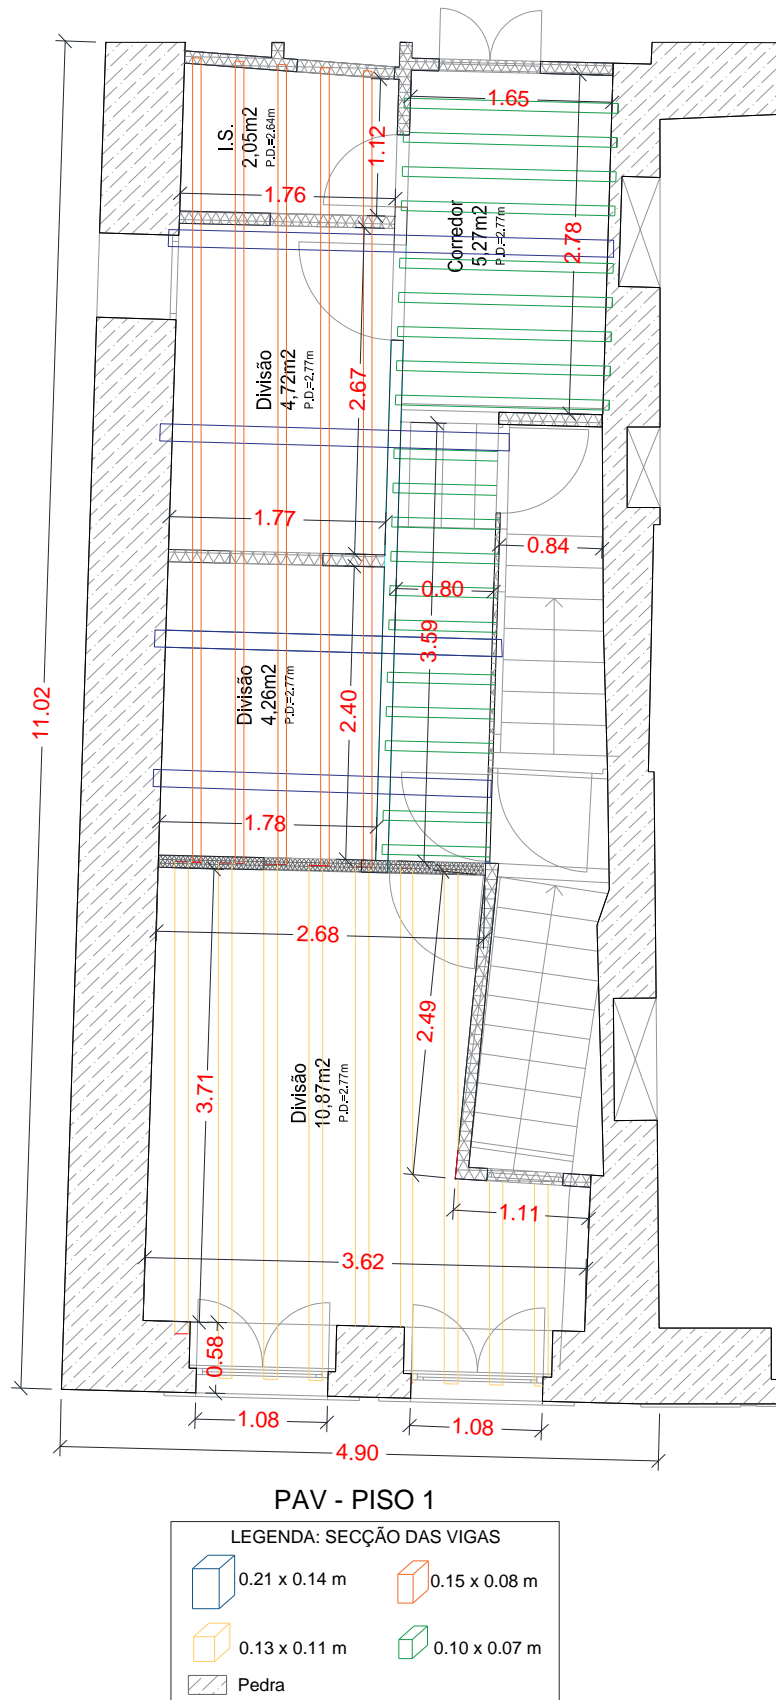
Disposição das vigas no pavimento do Piso 1
